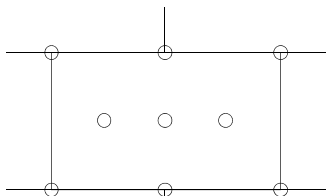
Panneaux ISOVER TF de dimensions 1000 × 600 mm - plans de chevillage en plein (espacement entre chevilles ≥ 230 mm)
